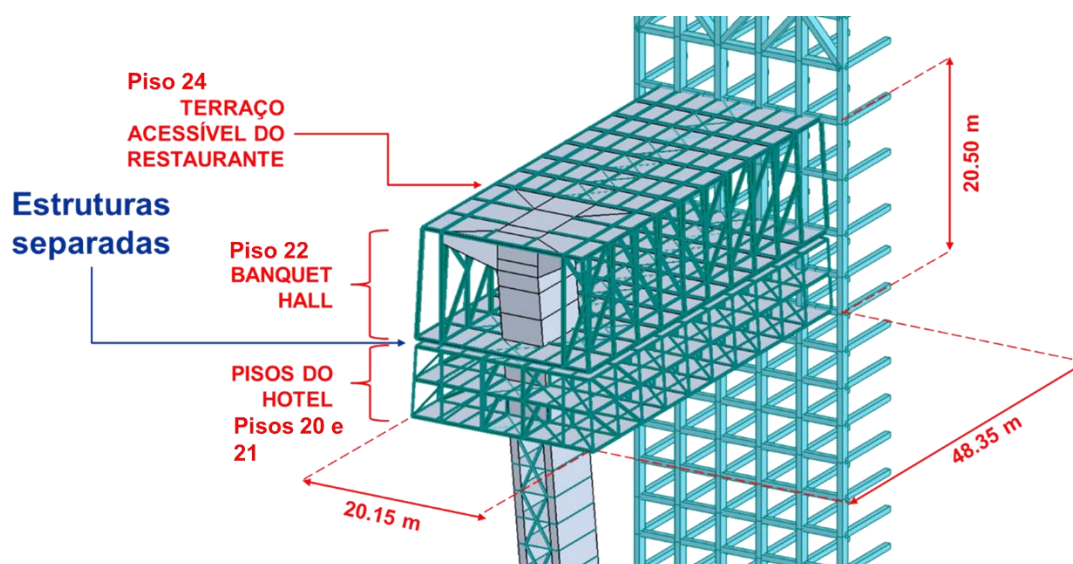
Dimensões e estrutura da Elevated Bridge. PPW aula da AdF
